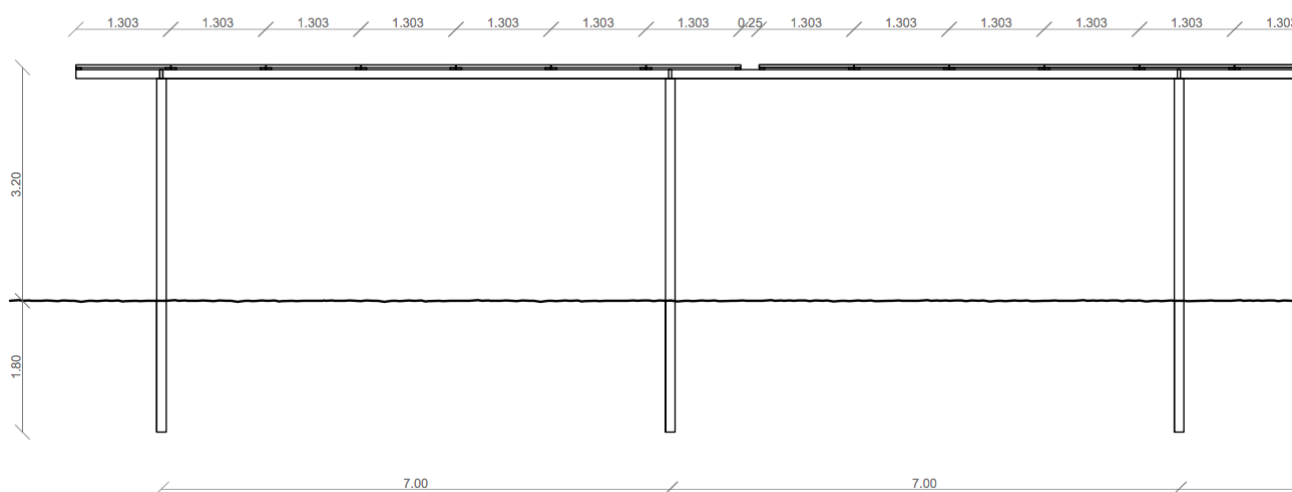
Prospetto longitudinale Tracker (vista Nord-Sud).
